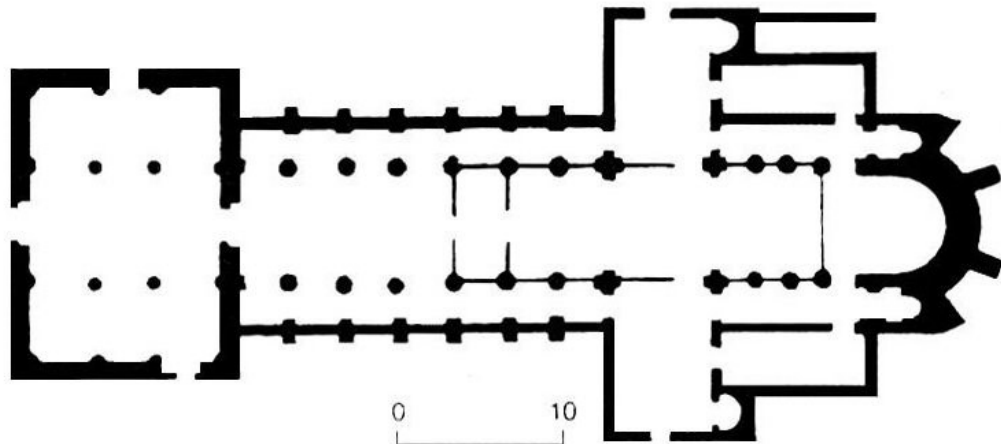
Cluny, Grundriss des Majolusbaues der Klosterkirche ("Cluny II")
